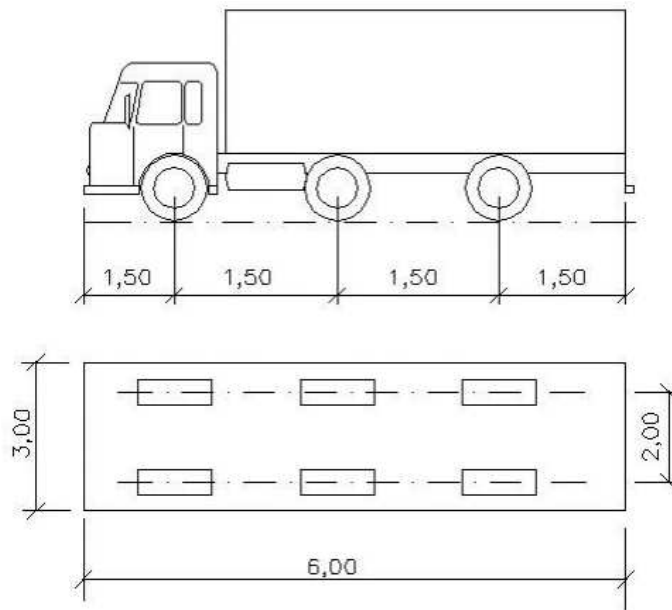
Trem tipo para pontes de classe 45. Dimensões em m.
